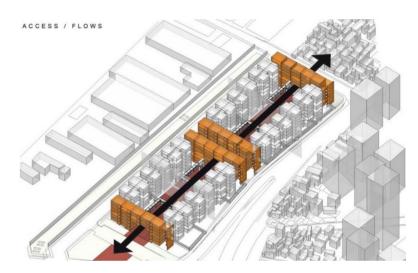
Distribución de bloques por colores Fuente: ( Plataforma Arquitectura, 2014)
